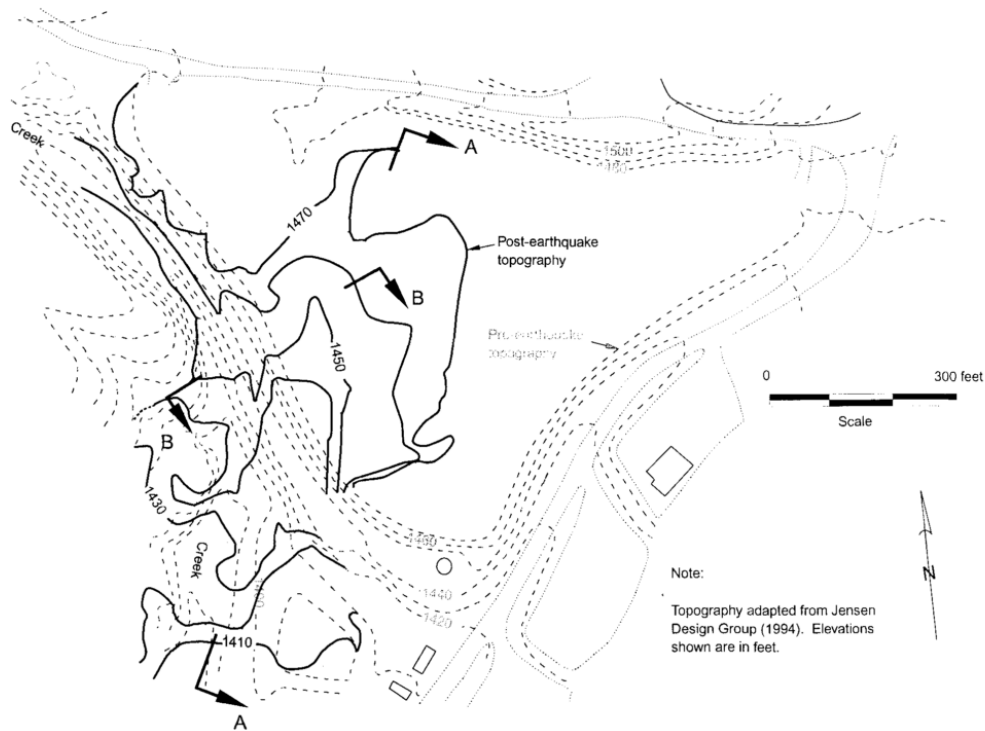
Planta da barragem Tapo Canyon indicando a geometria pré e pós ruptura (adaptado de HARDER & STEWART , 1996).
